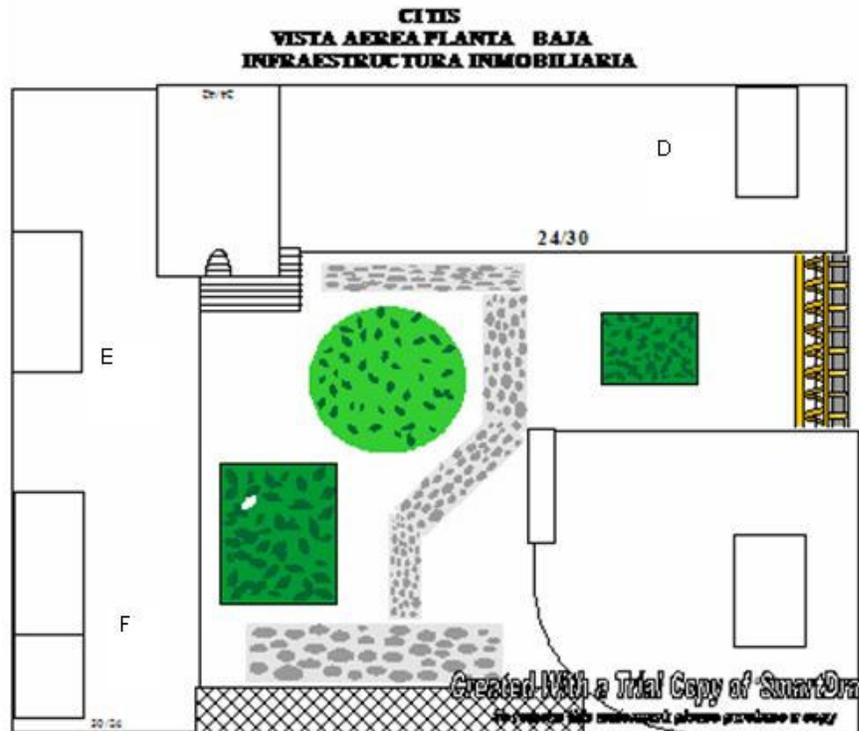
Secciones del CITIS donde puede ser implantado las terminales físicas en la planta baja.
